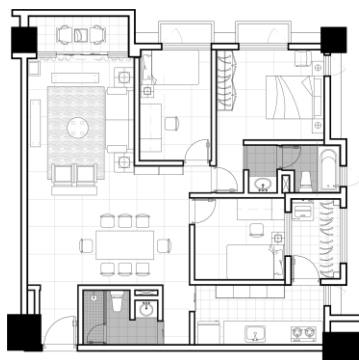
、「玩」廳住宅平面圖 圖 5、「食」廳住宅平面圖 圖 6、「作」廳住宅平面圖
